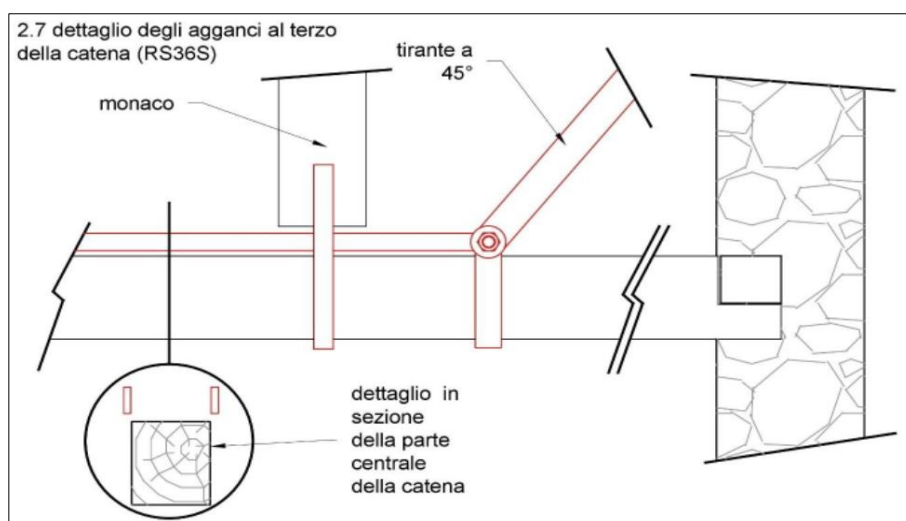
Schema della carpenteria metallica ancorata alla struttura lignea – Rilievo ditta InSitu
